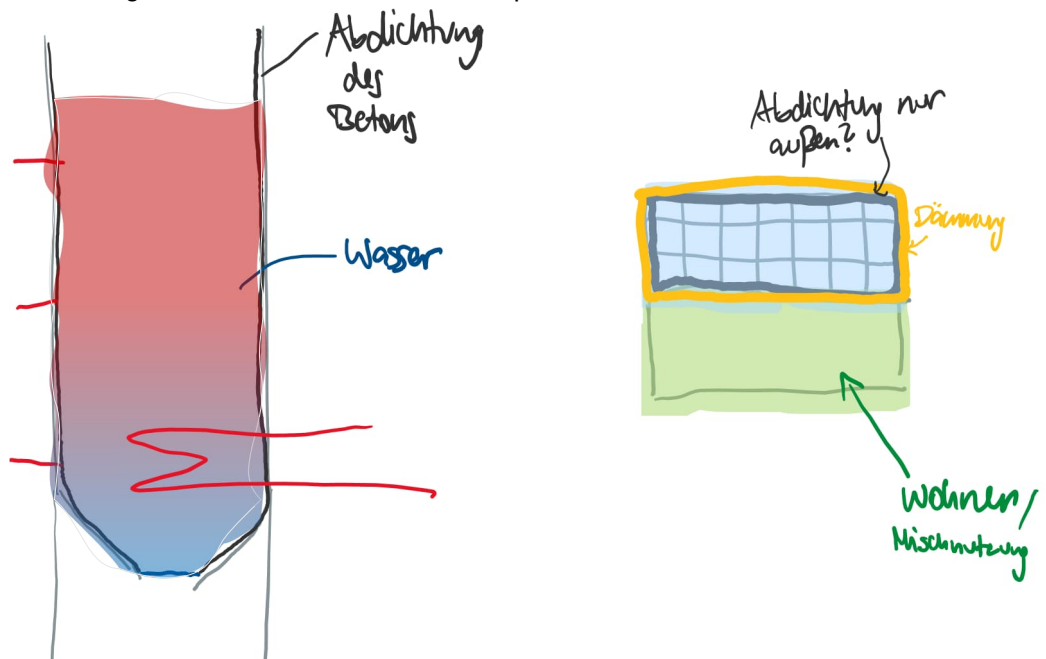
Konzeptskizze zum Einbau eines Warmwasserspeichers in den Getreidesilos. Links Schnitt eines Silos, rechts Grundriss eines Silogebäudes mit verschiedenen Nutzungen
